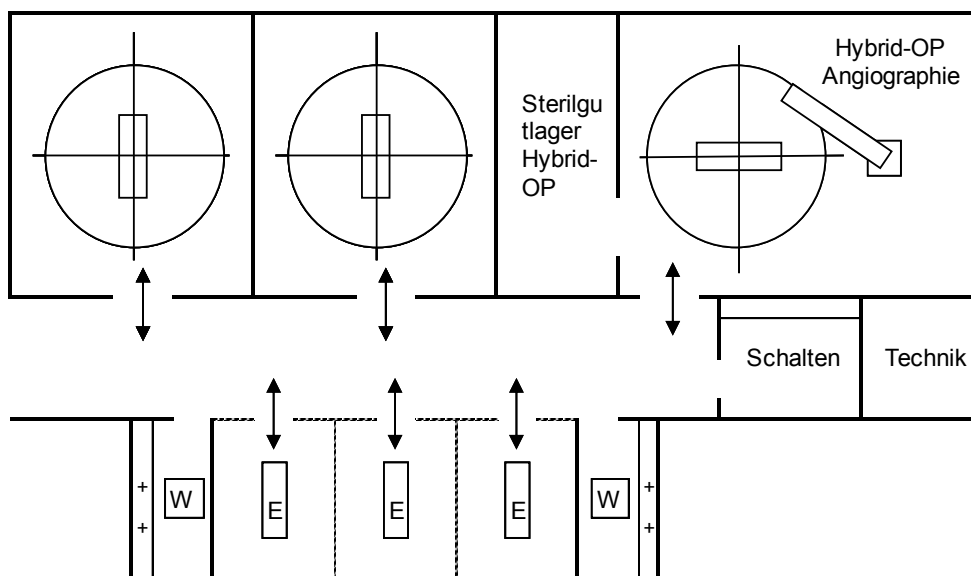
Systemgrundriss Hybrid-OP mit Angiographie
